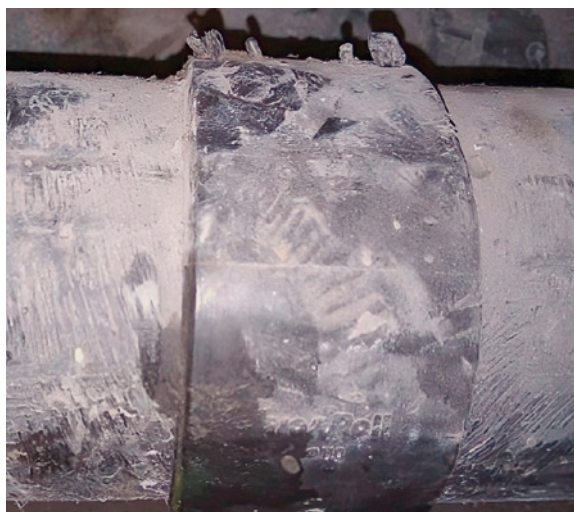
Thermosoudage déféctueux à gauche (témoin de soudure inexistant) et correct à droite qui montre l'expulsion du témoin de soudage
